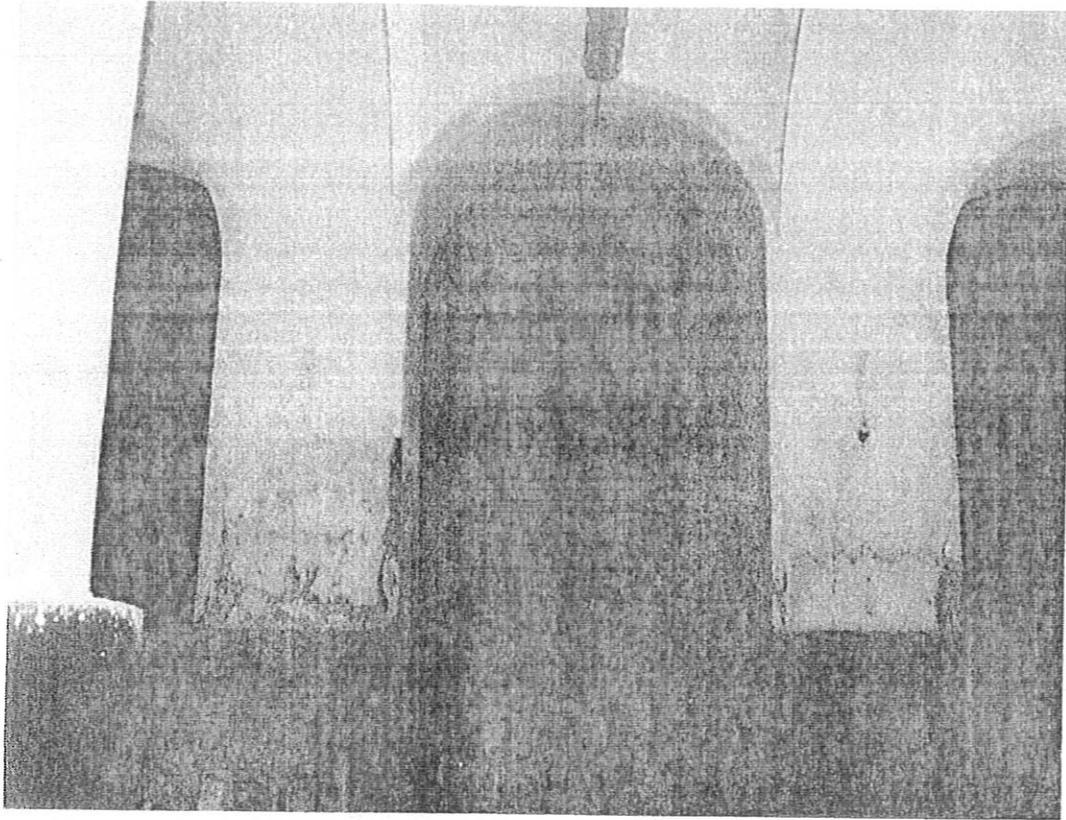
Primo piano dei pilastri crollati; vista verso nord
